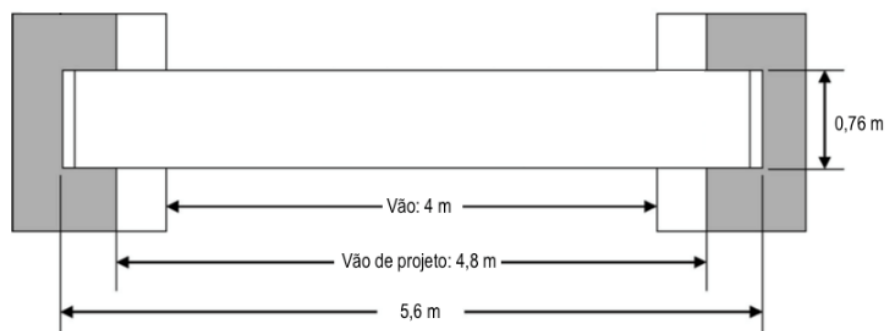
Seção transversal de um dos pisos de rodagem
